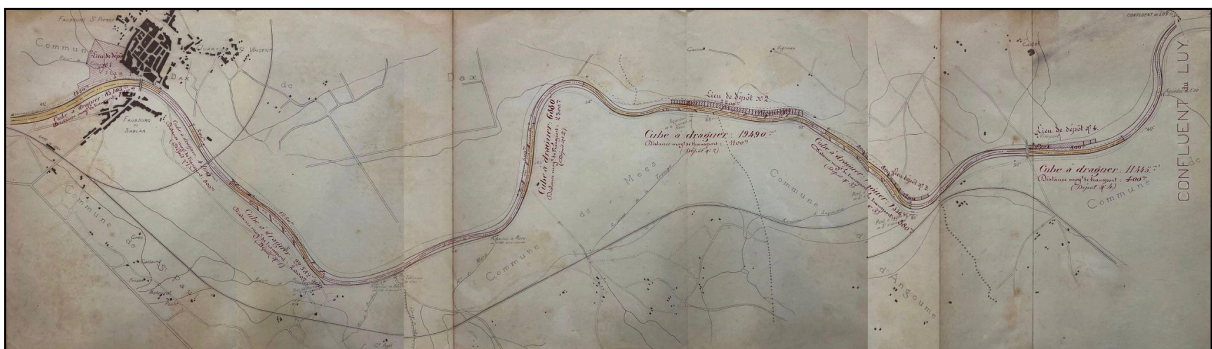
Plan général du plan définitif du projet d'amélioration de la navigabilité de l'Adour entre le confluent du Luy et la ville de Dax, 1896 (Source : AD 40, 3 S 107).
